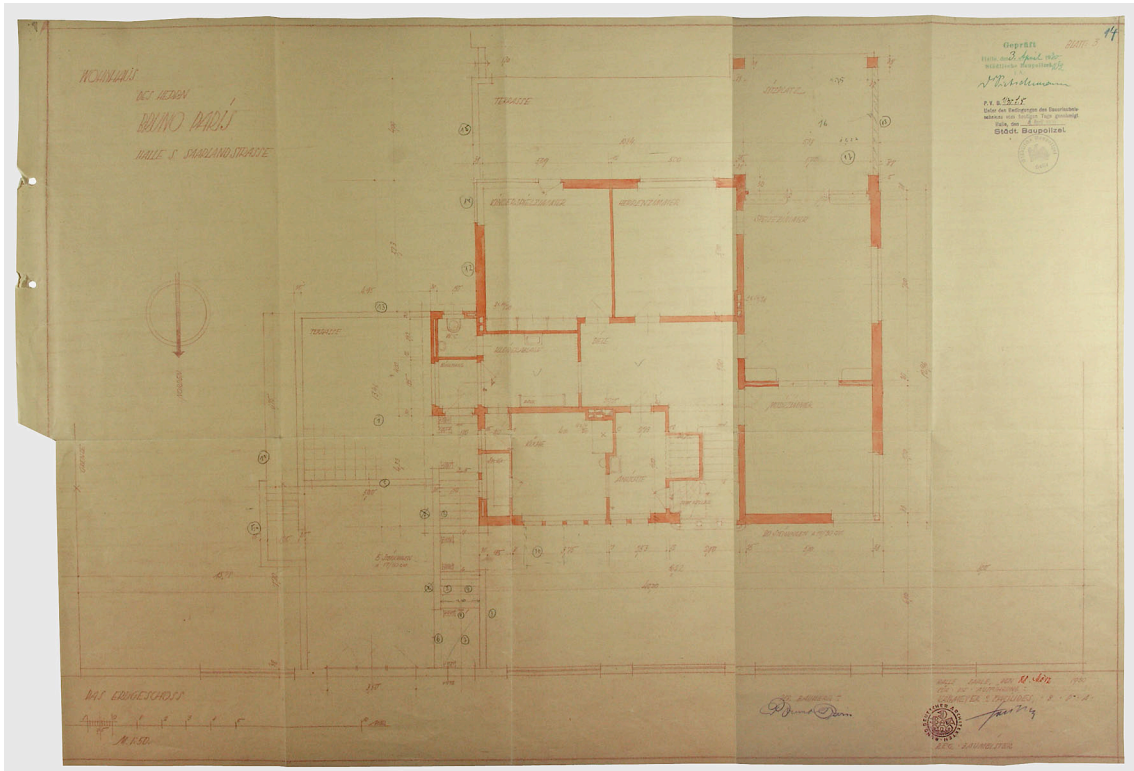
Wohnhaus in der Ernst-Grube-Straße 24 in Halle, Grundriss Erdgeschoss, datiert 28. März 1930.
